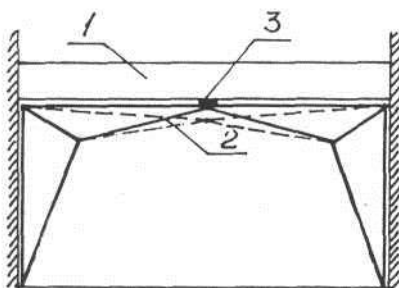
(1 — усиливаемая балка, 2 — порталная рама, 3 — прокладка)
